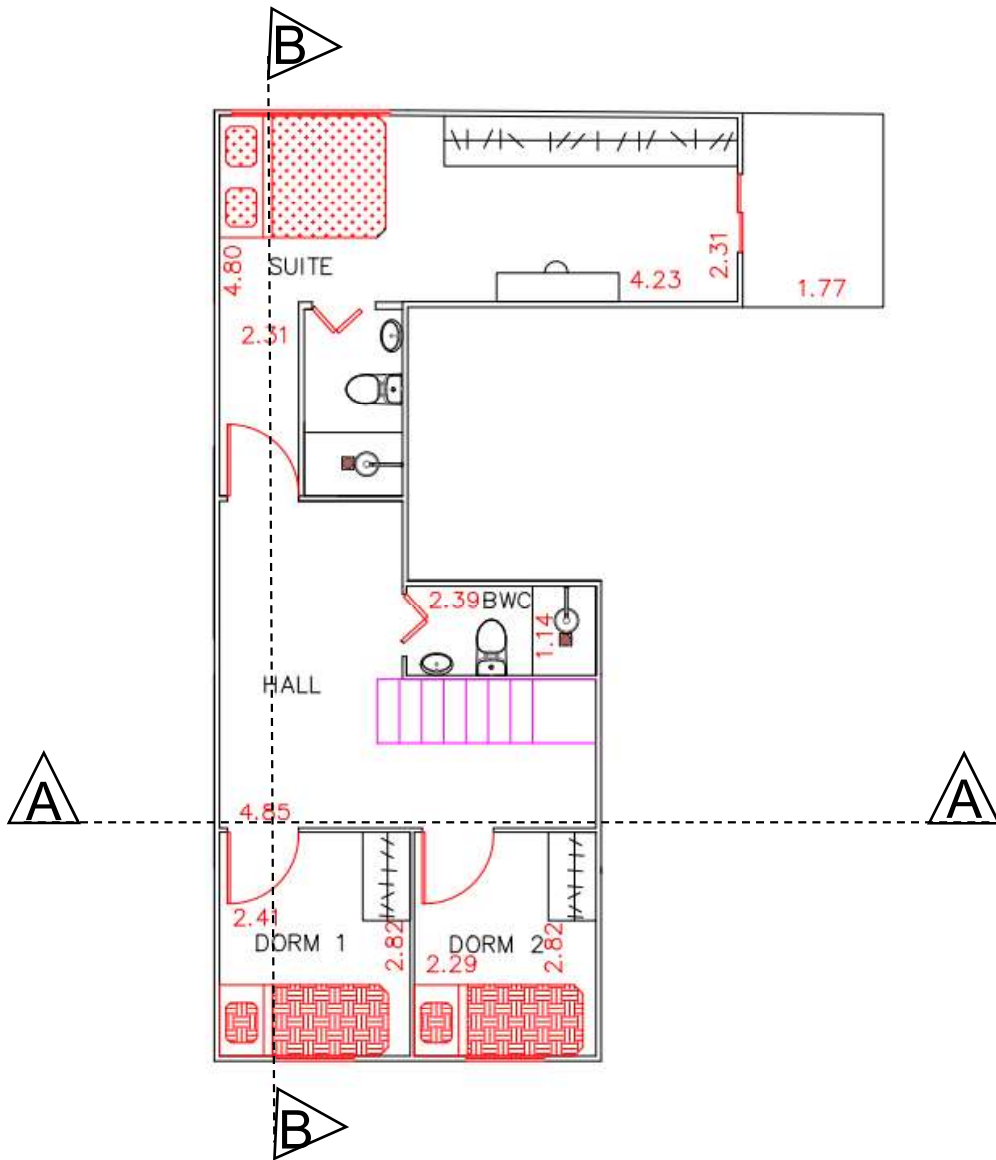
PROJETO, PAVIMENTO SUPERIOR.
